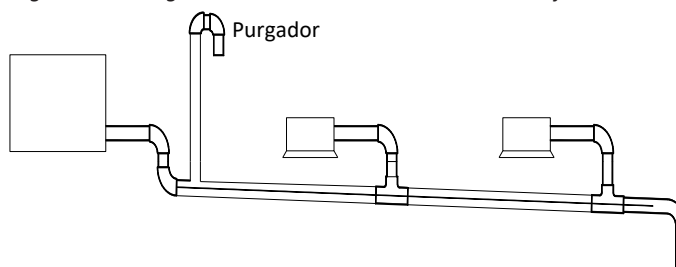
Purgadores de aire de las tuberías de drenaje
